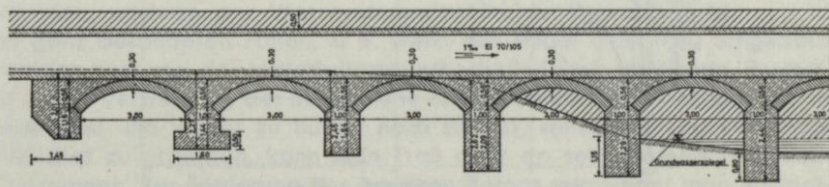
Pfeilergründung mit Betongurten (Verstärktes Elprofil I 0,70/1,05 m)
